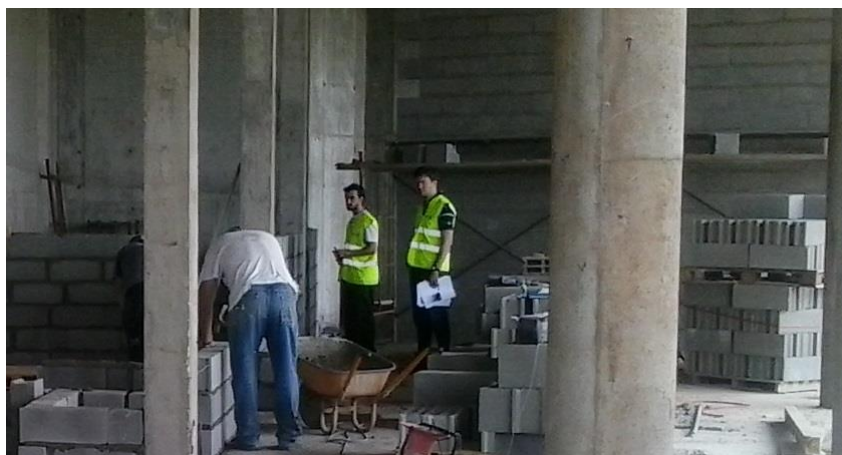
Coordenação da execução das paredes em alvenaria de blocos de cimento do edifício do *spa*.
